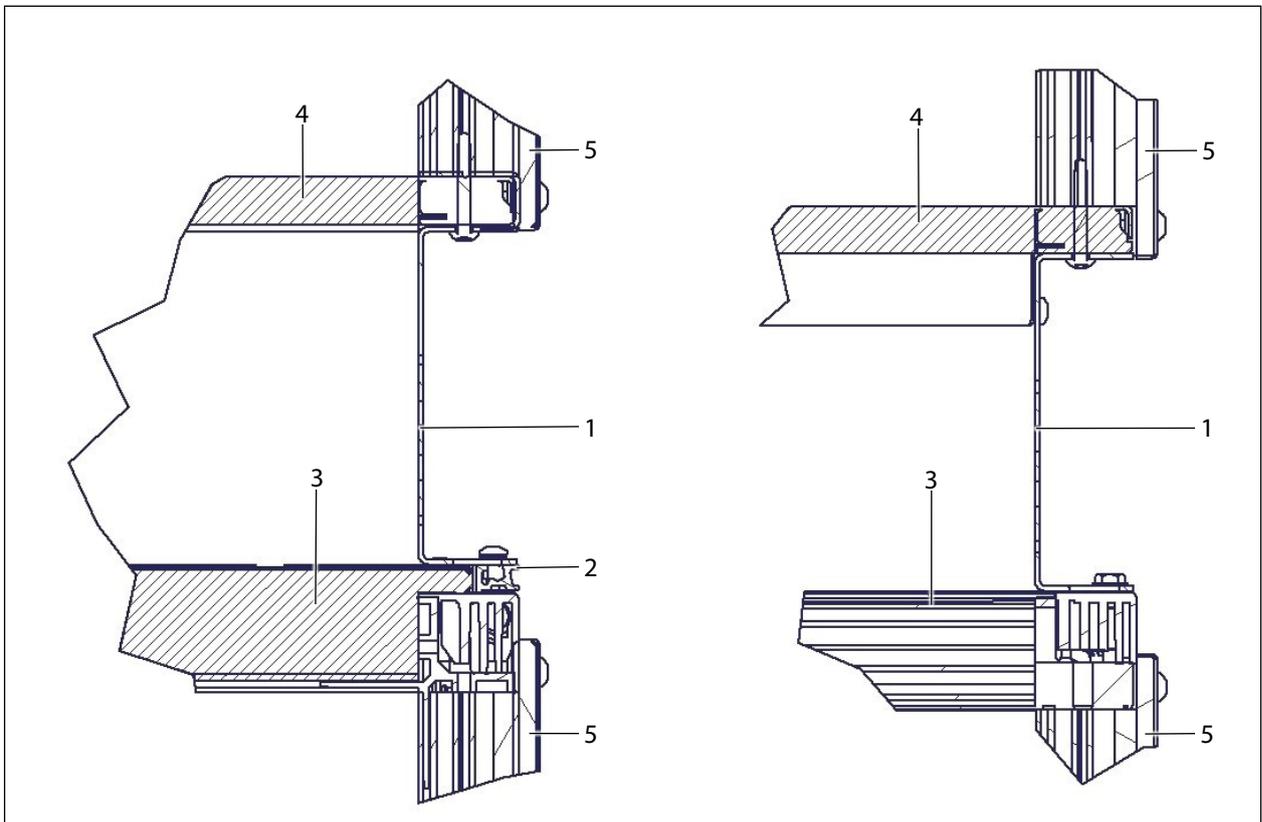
Disposition des appareils groupe de toit avec profil de cadre d'appareil (à gauche) et sans profil de cadre d'appareil (à droite)
